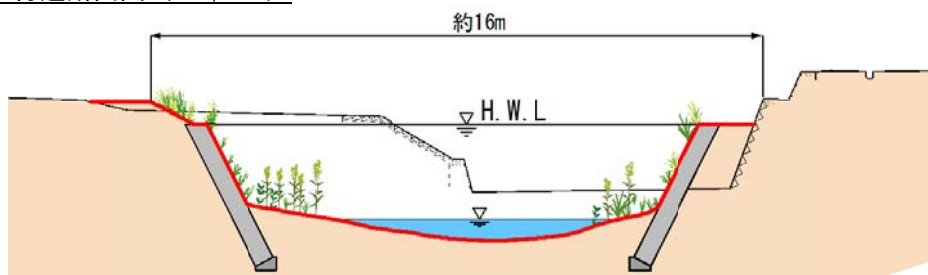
山犬原川整備計画平面図（工事施行の場所）及び代表断面図
